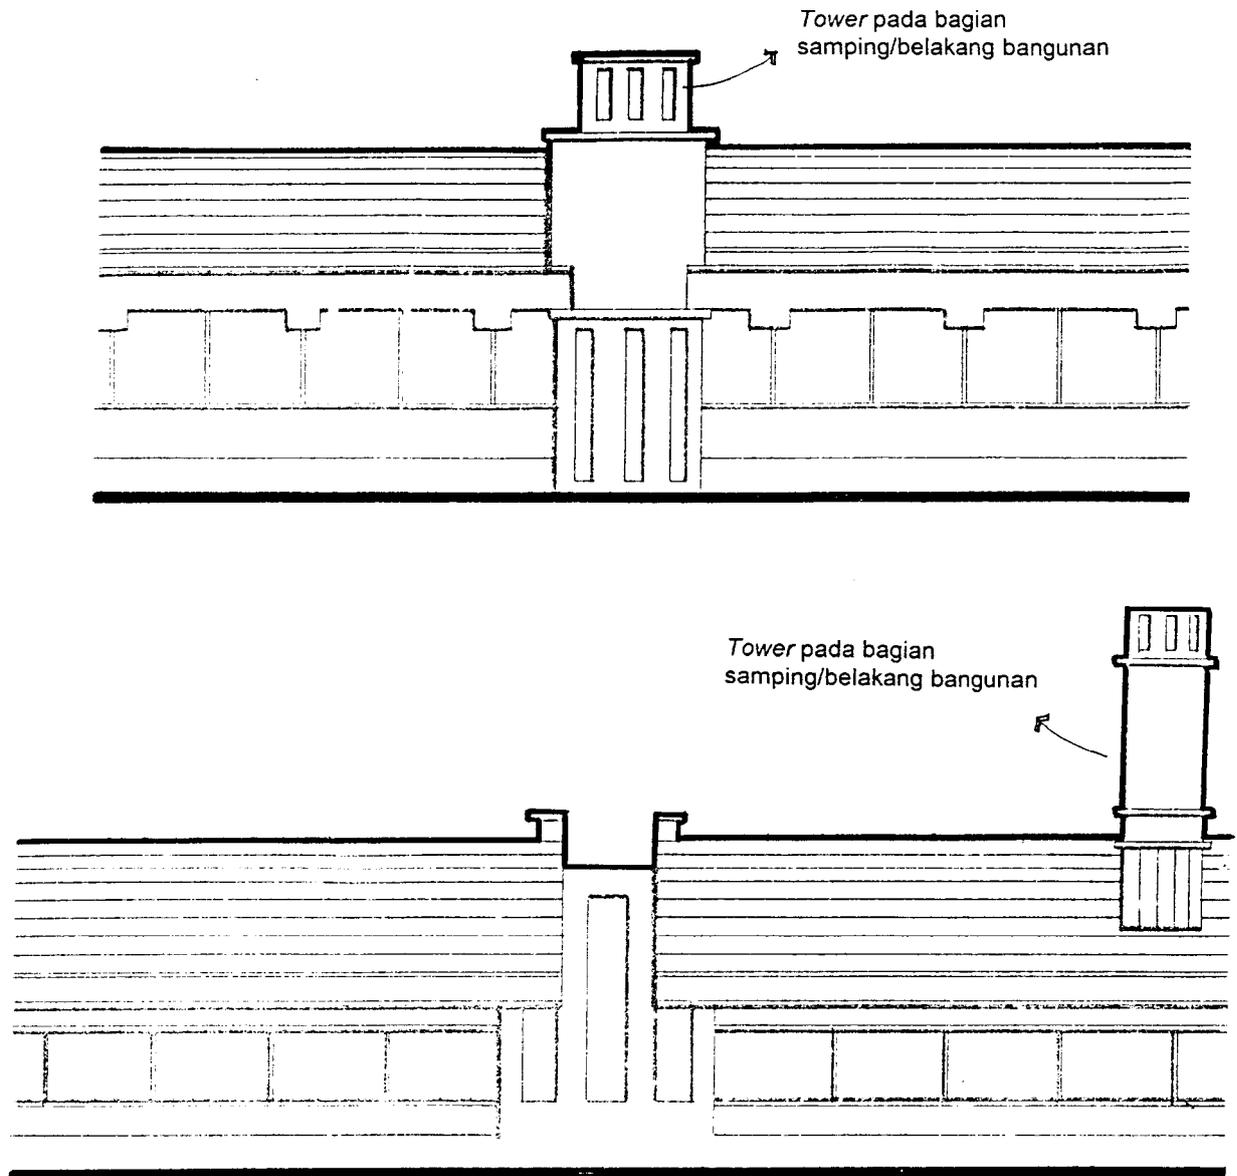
Konsep Penampilan Bangunan dengan Deretan Kolom
